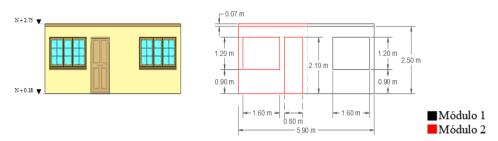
Vista y dimensionamiento de fachada frontal de la vivienda mínima modular.
